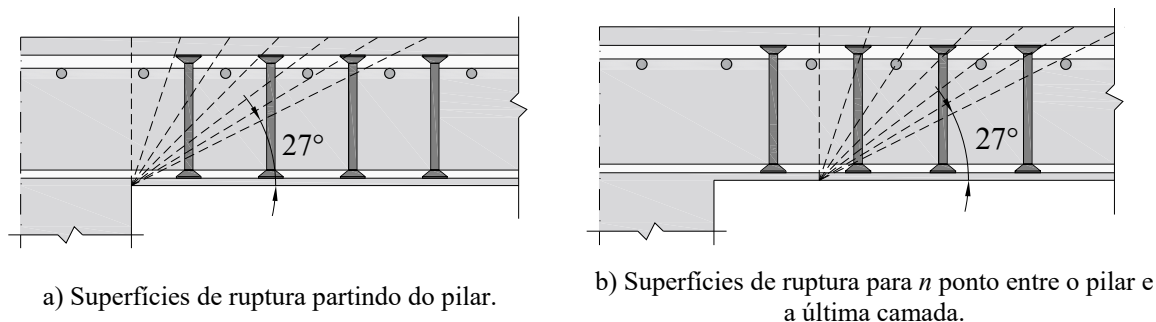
Possibilidades de superfície de ruptura em ligações laje-pilar armadas à punção segundo BIRKLE (2004).
